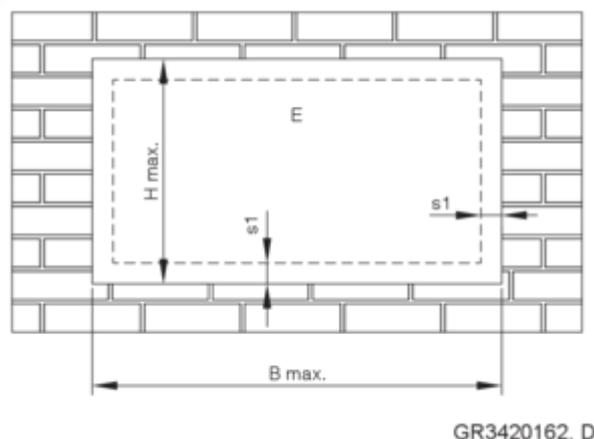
Placa de enformagem contra incêndios - montagem em paredes e tetos maciços, divisórias leves, paredes com vigas de madeira, estrutura em enxaimel e paredes de madeira maciça
